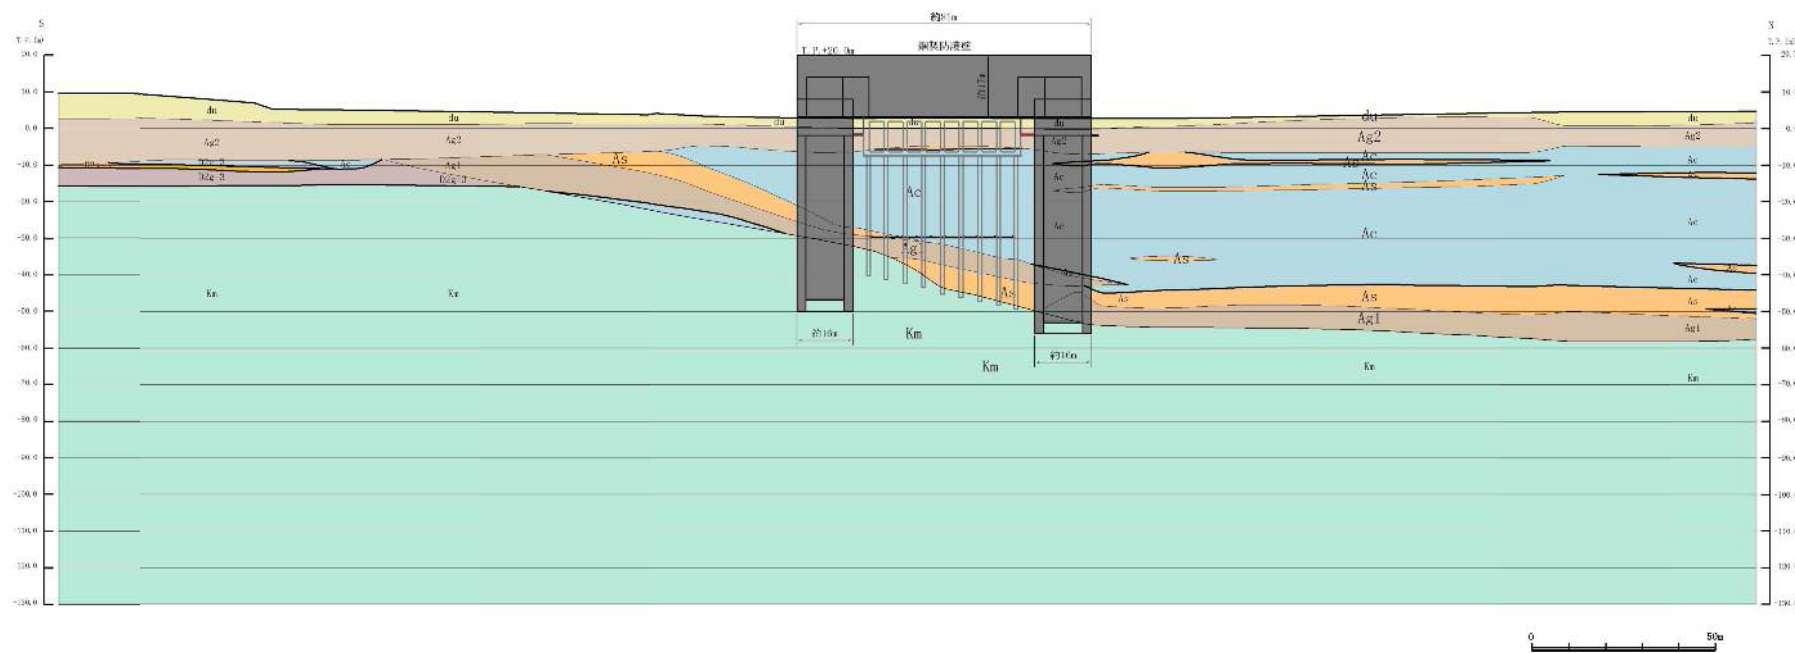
(1) 鋼製防護壁断面図(A-A断面)
